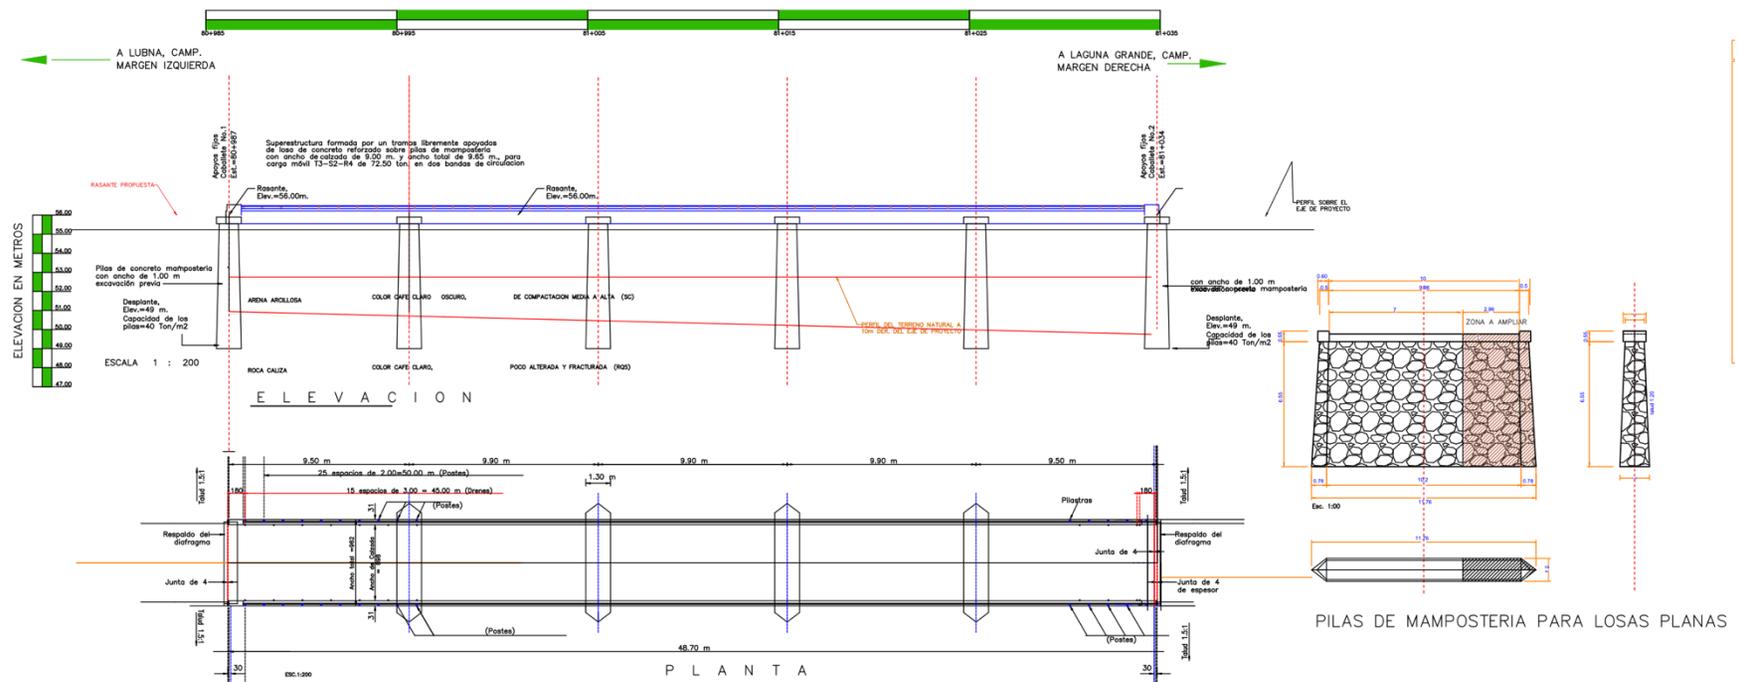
Sección estructural en elevación y en planta del puente Chantón, Km 81+013.15
